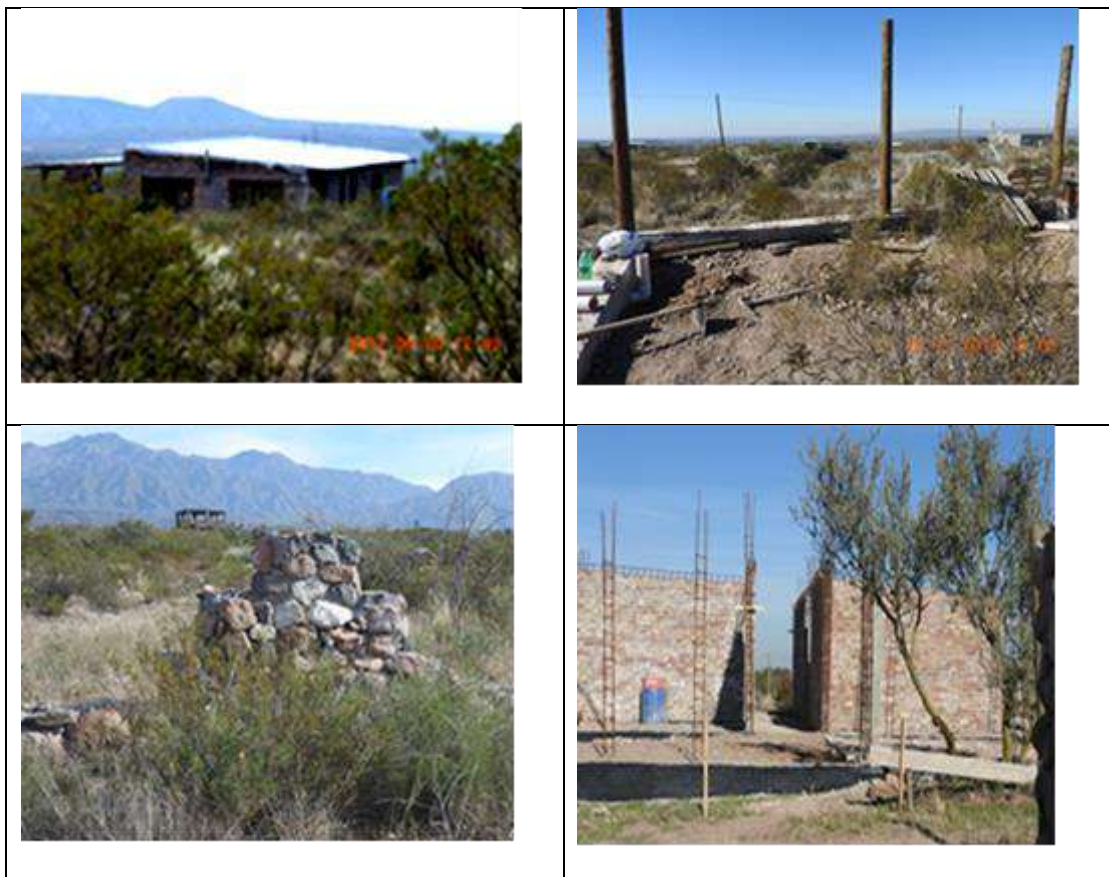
Tipos de construcciones en zona de piedemonte no consolidado (subárea E)
